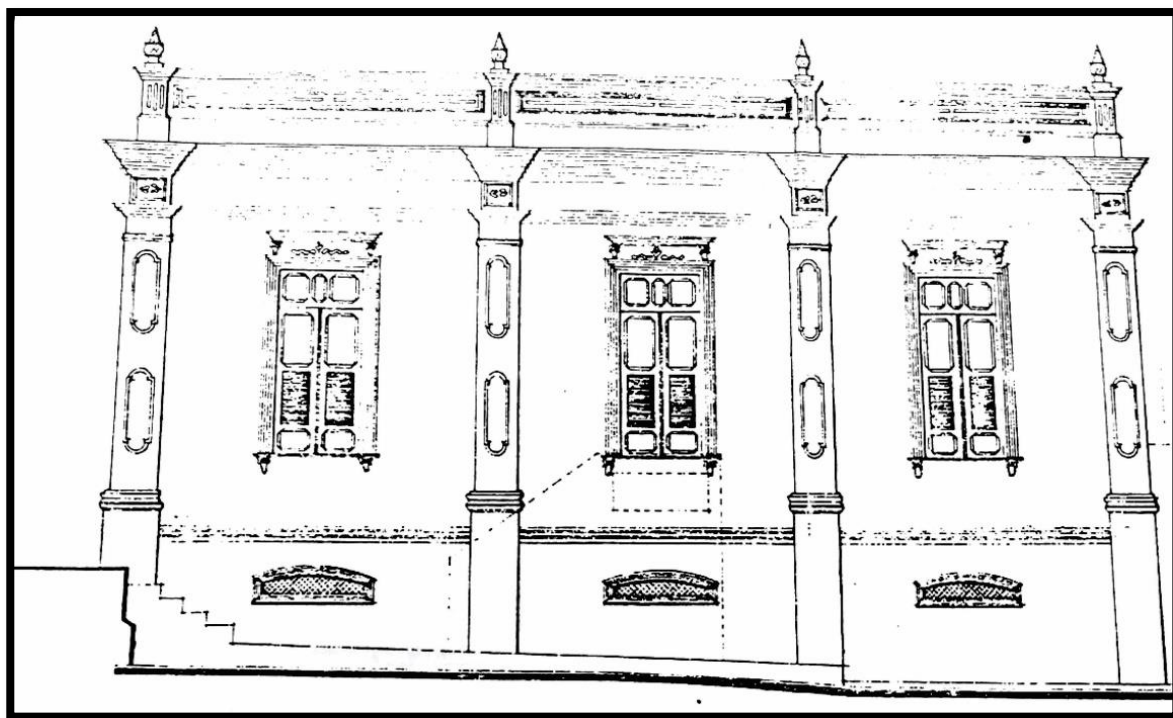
Fachada noroeste – pavilhão lateral esquerdo.
